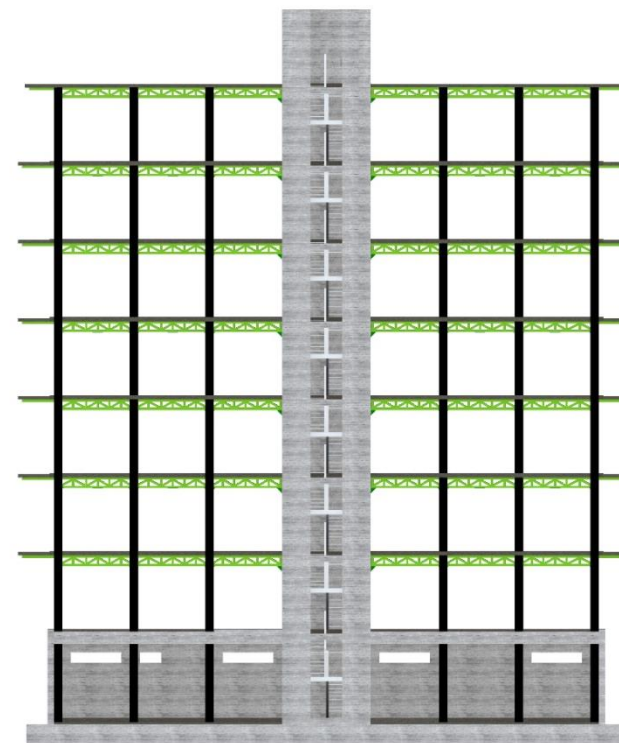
Sistema de Marcos Metálicos en Estructuras de los Edificios
